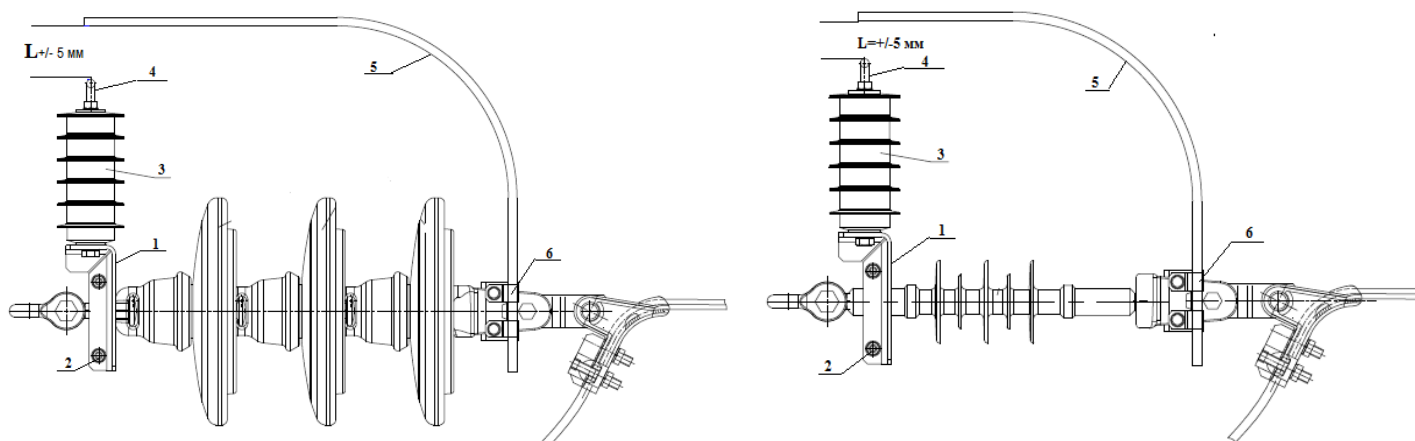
Установка устройства на натяжную стеклянную и полимерную изоляцию.
